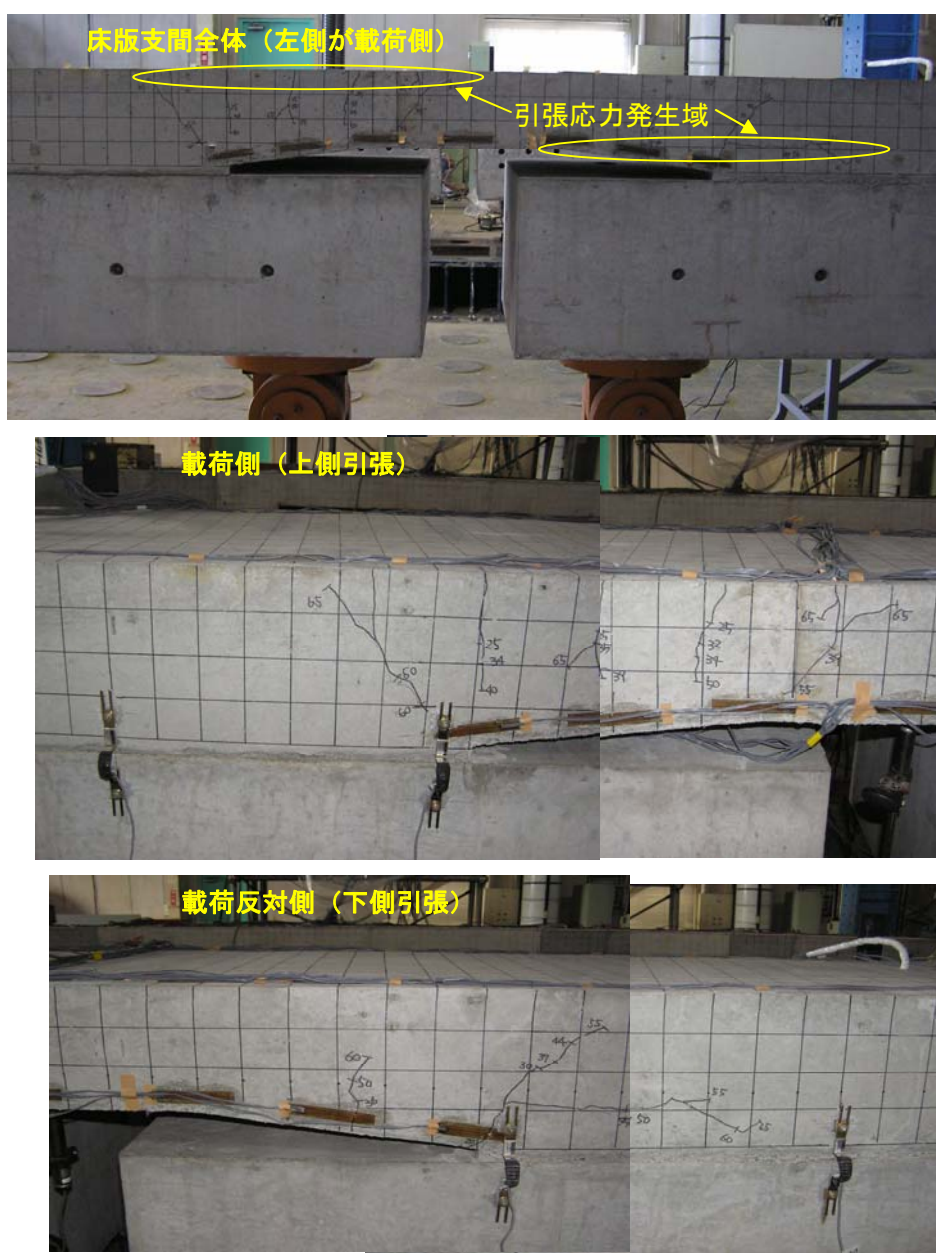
Type-1 ひび割れ発生状況
